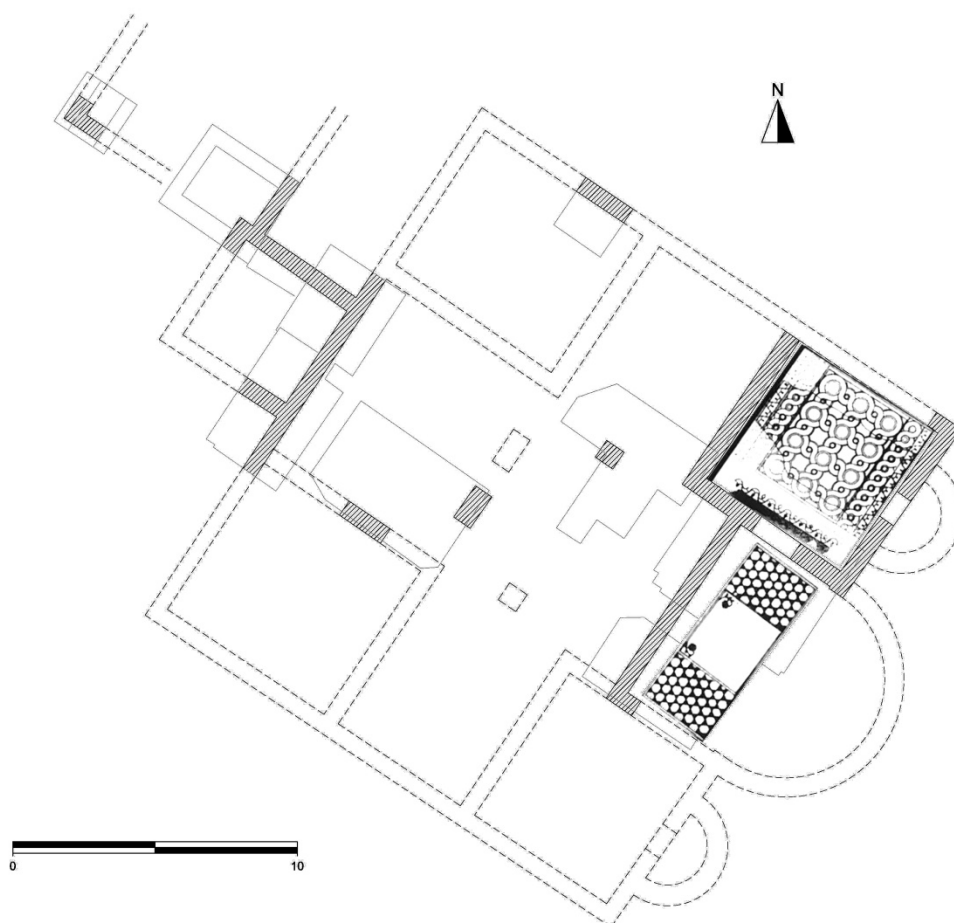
Plano de las estructuras excavadas por Pedro Marfil en Santa Clara y restitución según su hipótesis (Elaboración propia a partir de MARFIL, 2000: 168).
